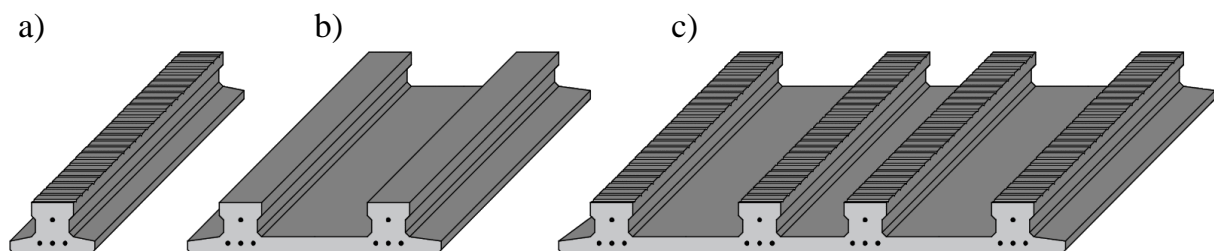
Płyta stropu Teriva Panel z betonem lekkim w przestrzeni międzyżebrowej
